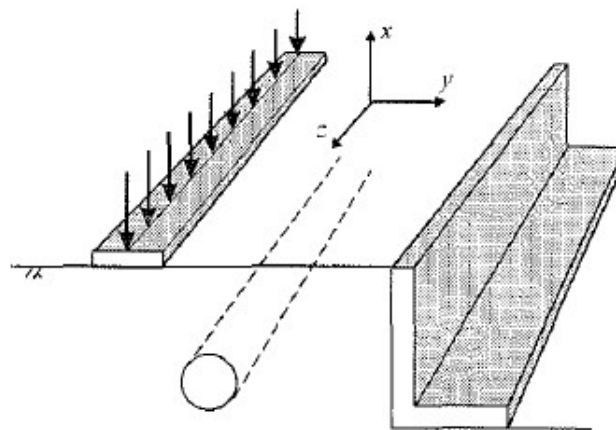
Exemplo do estado plano de deformações, (POTTS e ZDRAVKOVIC, 1999).
